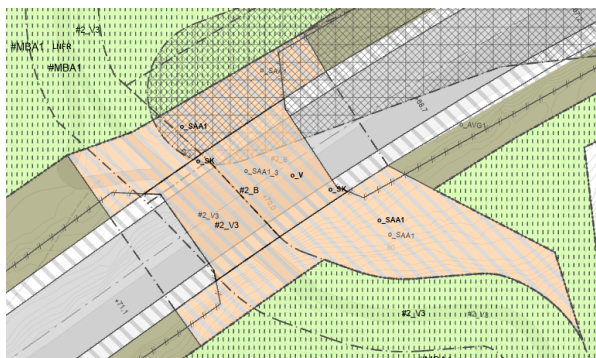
Viser høringsforslagets planlagte faunapassasje på Plassen. (Kilde: Sweco)
